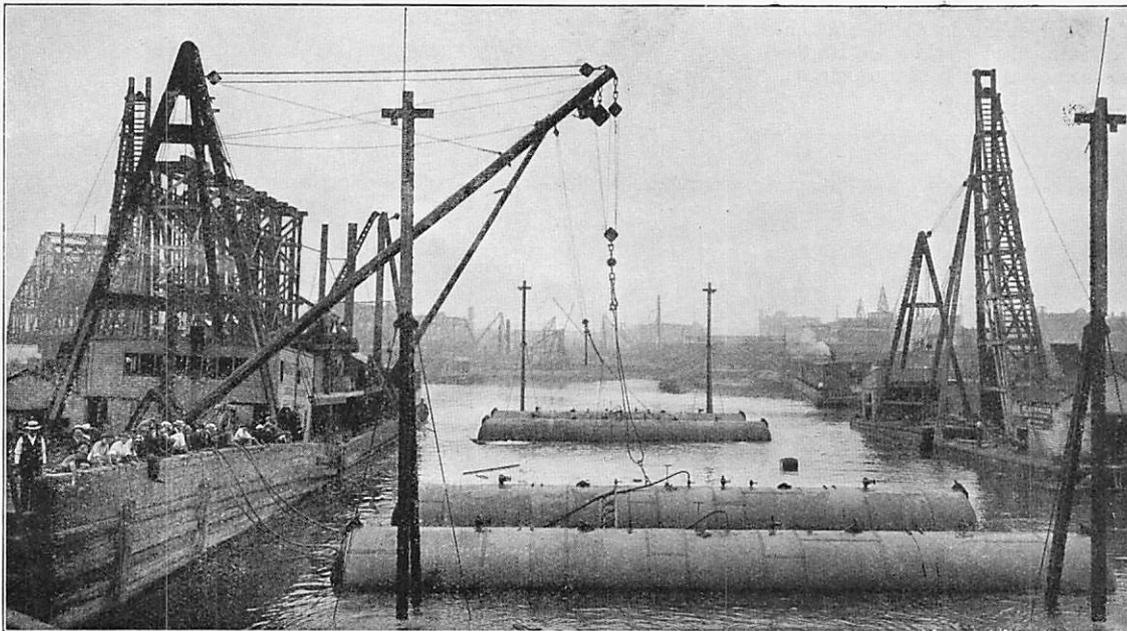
Untergrundbahn in der Lexington-Avenue in Neuyork. Bau des Harlem-Flufs-Tunnels. Ein Tunnelstück während des Schleppens zur Versenkstelle.
